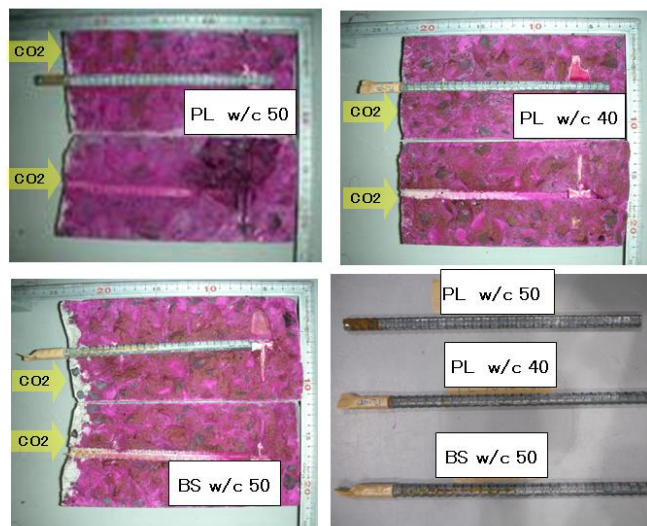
鉄筋近傍の中性化進行及び鉄筋腐食状況
